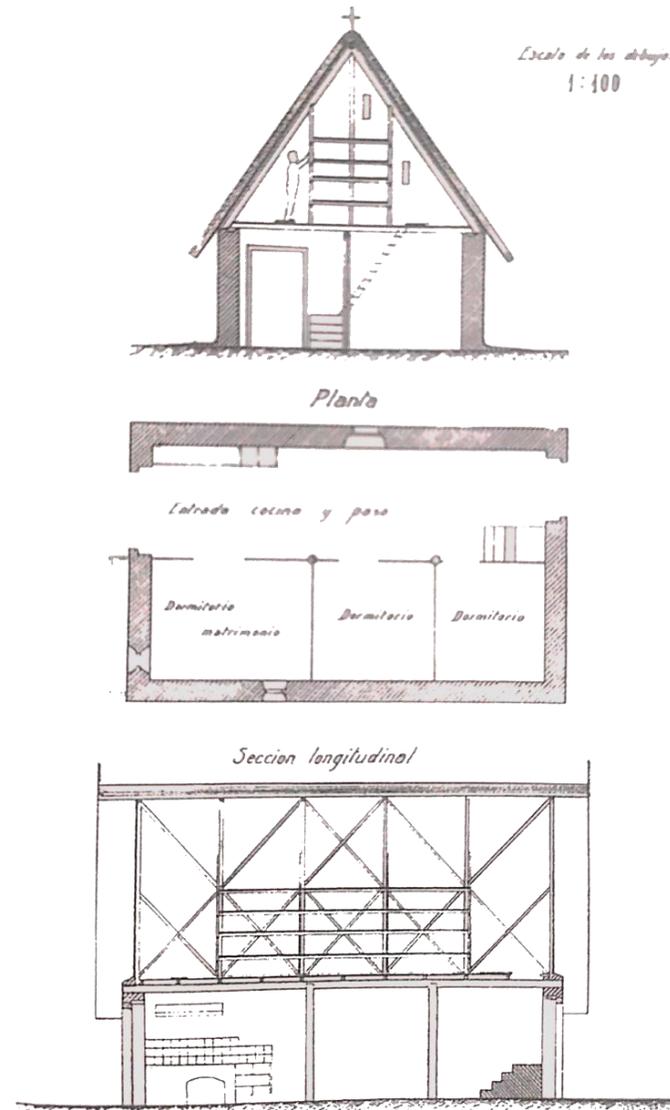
Planta, alzado y sección de una barraca con “passadis”. V. Gosálvez.
